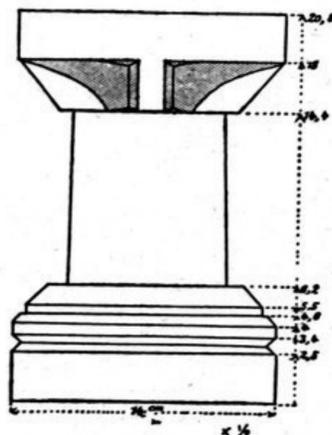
Pierre de taille d'un pilastre (TK, 13).
